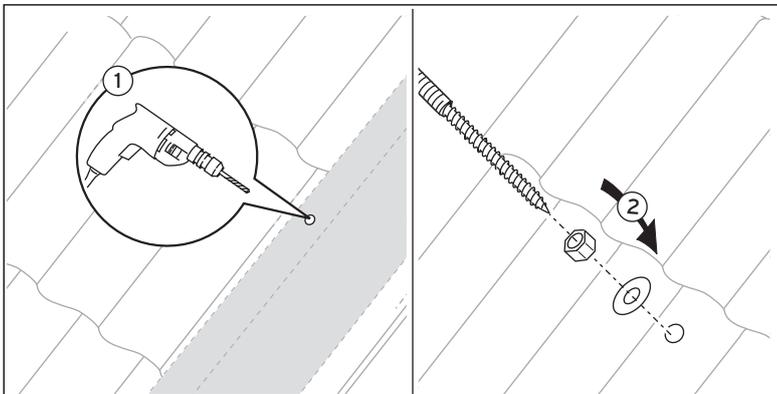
Position des Dachankers auf dem Dachsparren festlegen
